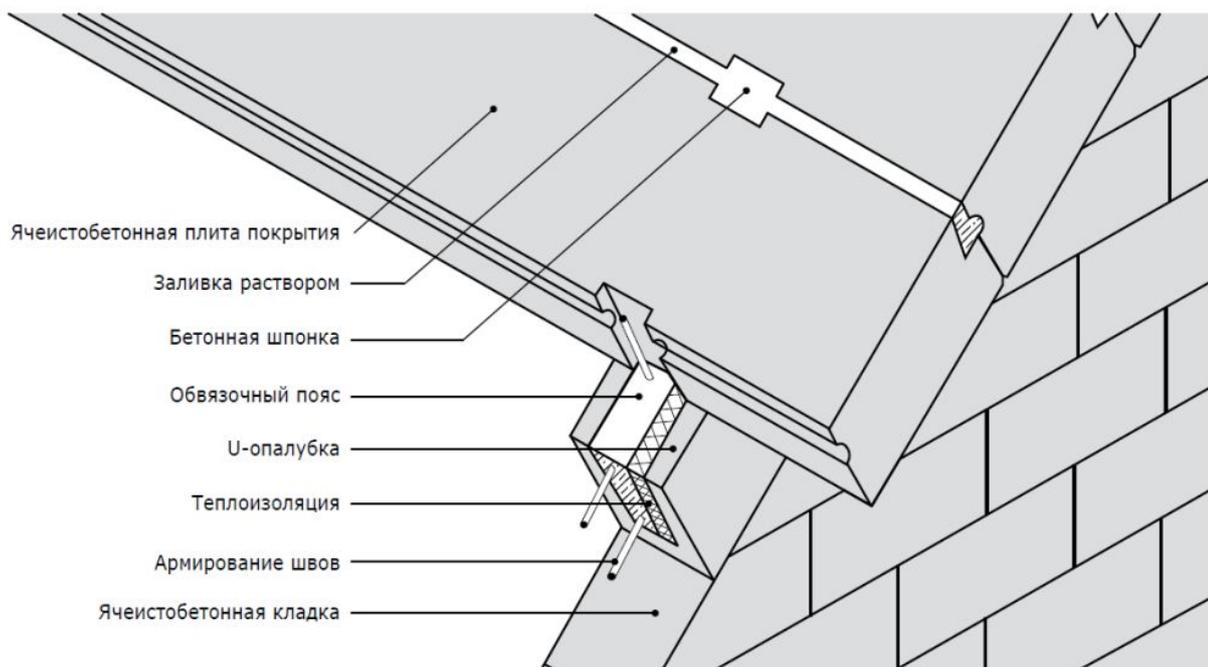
Зона сопряжения стена-покрытие. Консольное опирание панелей покрытия на кладку фронтона, обвязочный пояс в лотковых блоках под панелями
